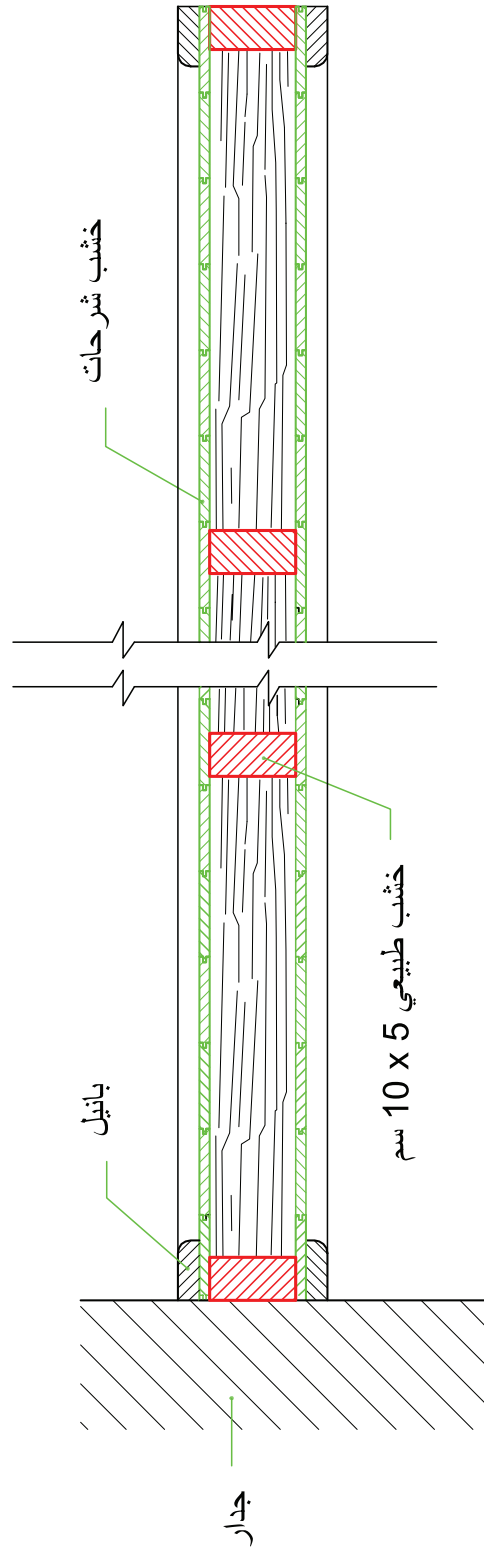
مسقط أمامي لقاطع خشب قبل التغطية
